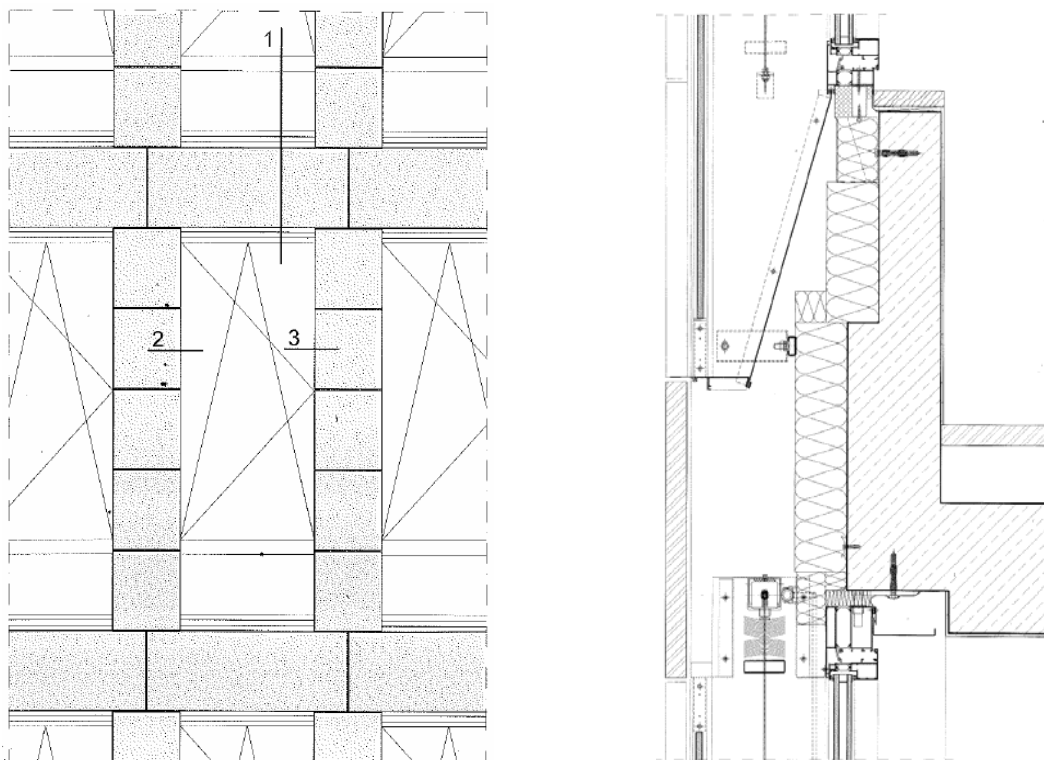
Fachada de doble piel tipo cajón. Alzado frontal y sección vertical
